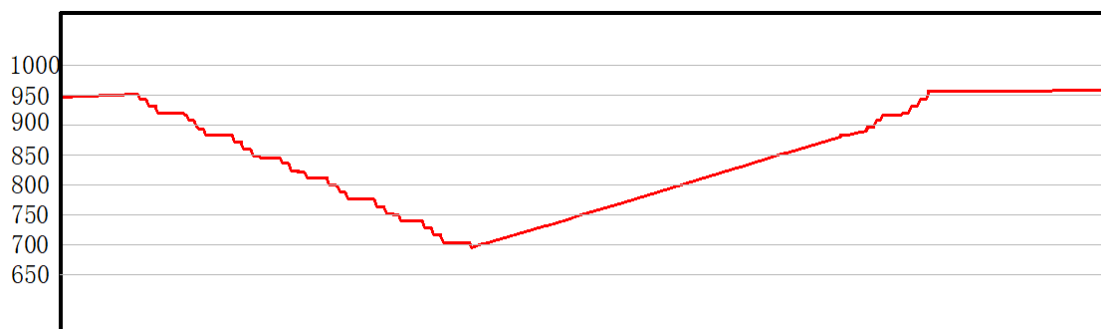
扎哈淖尔露天煤矿采掘场 P1 线剖面图
